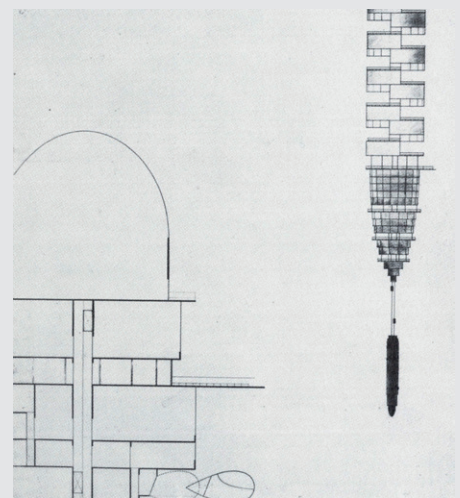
tercer tipo de vivienda, para parada temporal, tipo hotel
